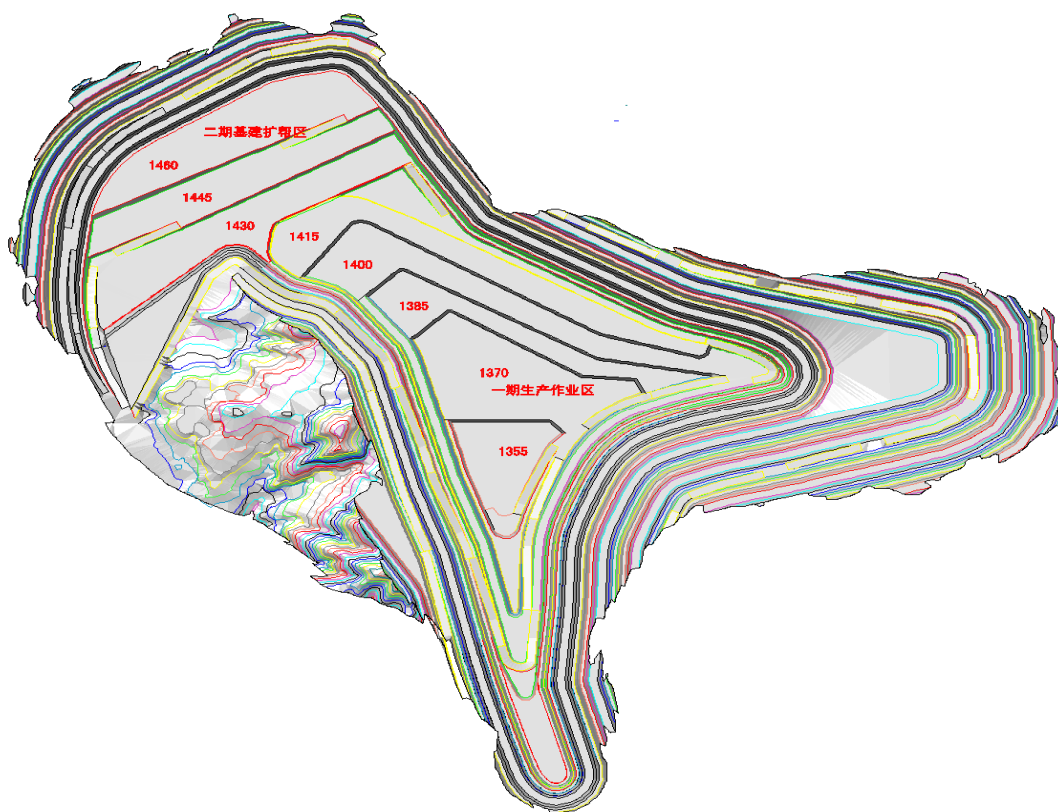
一期、二期露天开采衔接平面接示意图
